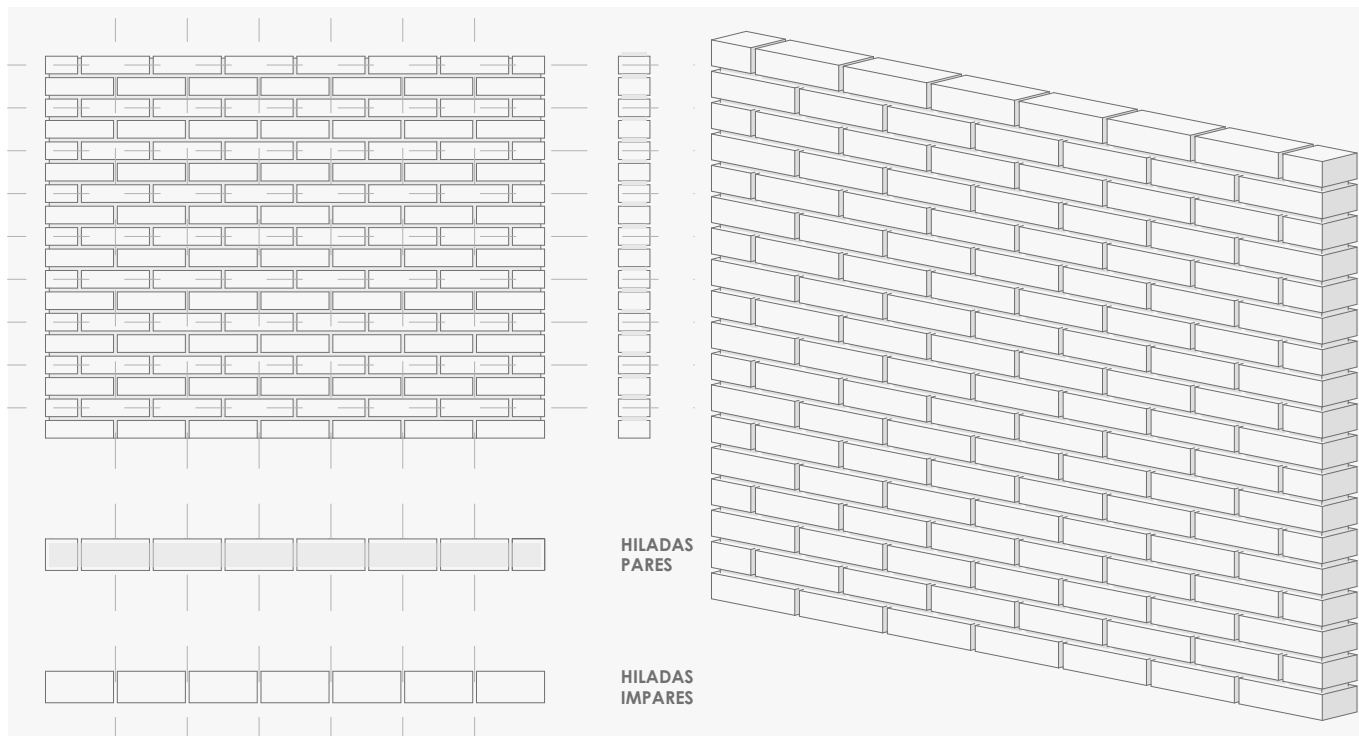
Ilustración del ladrillo en el detalle constructivo 1.
